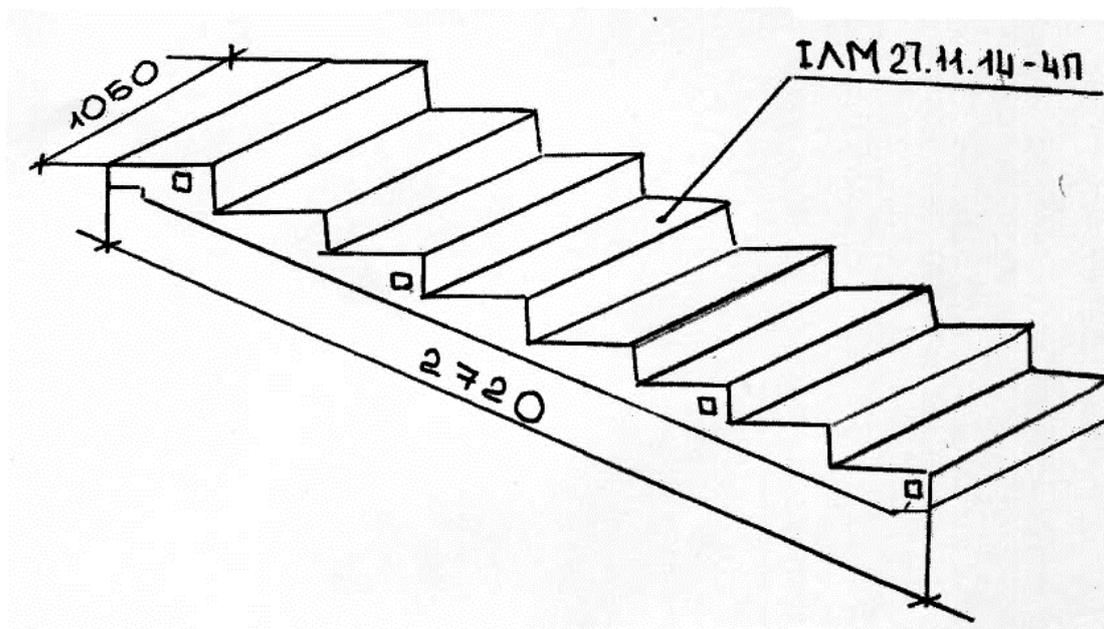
Марш лестничный железобетонный плоский для жилых зданий с высотой этажа 3,0м
